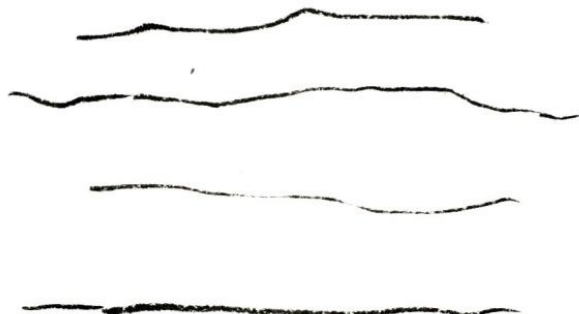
Detalle de fisuras por retracción u asentamiento plástico sobre armaduras.
